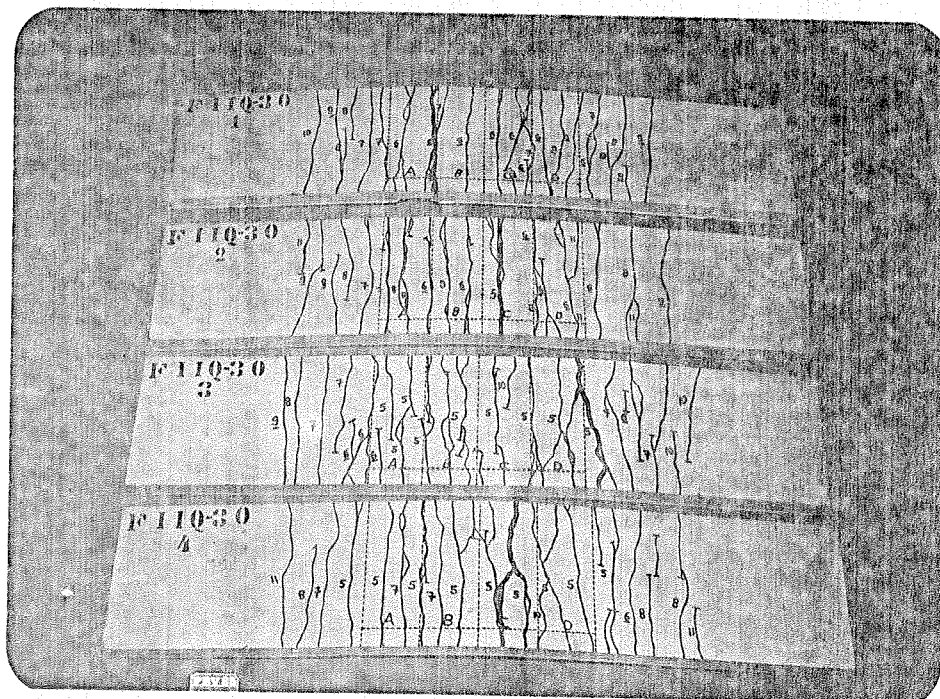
Fissuração final - SERIE F11Q30
